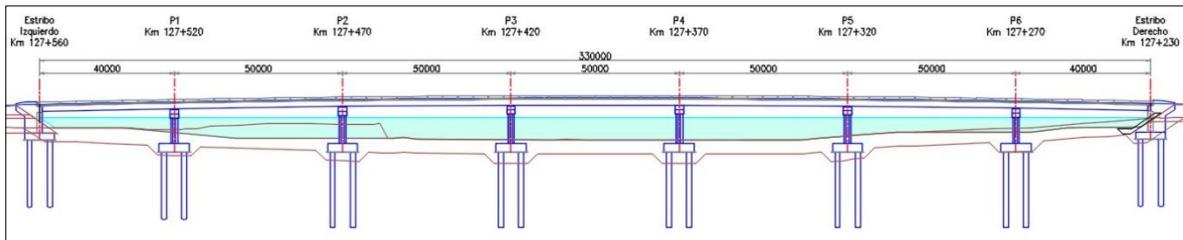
Puente Independencia (330.00 m) vista perfil, tramo principal.
